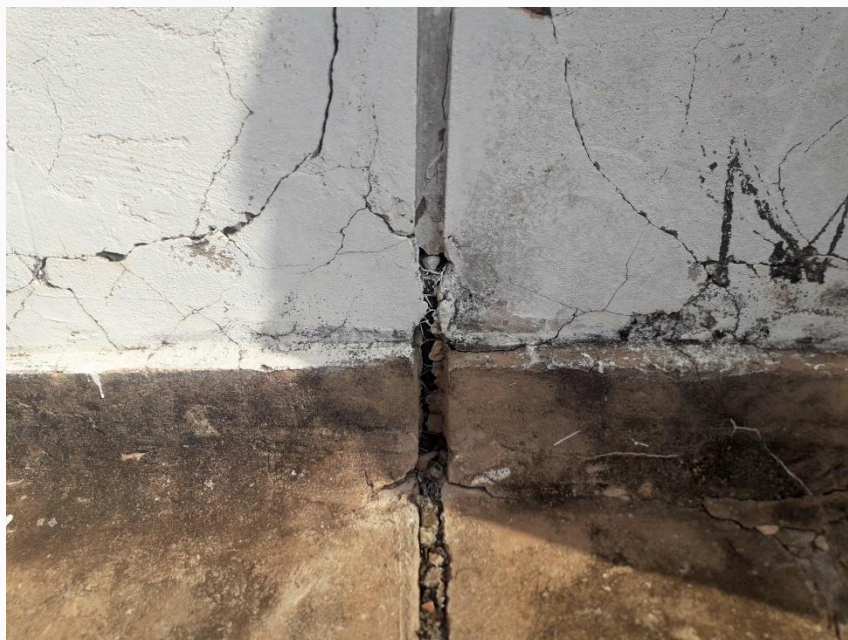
Junta de dilatação na laje deteriorada, sem vedação.
